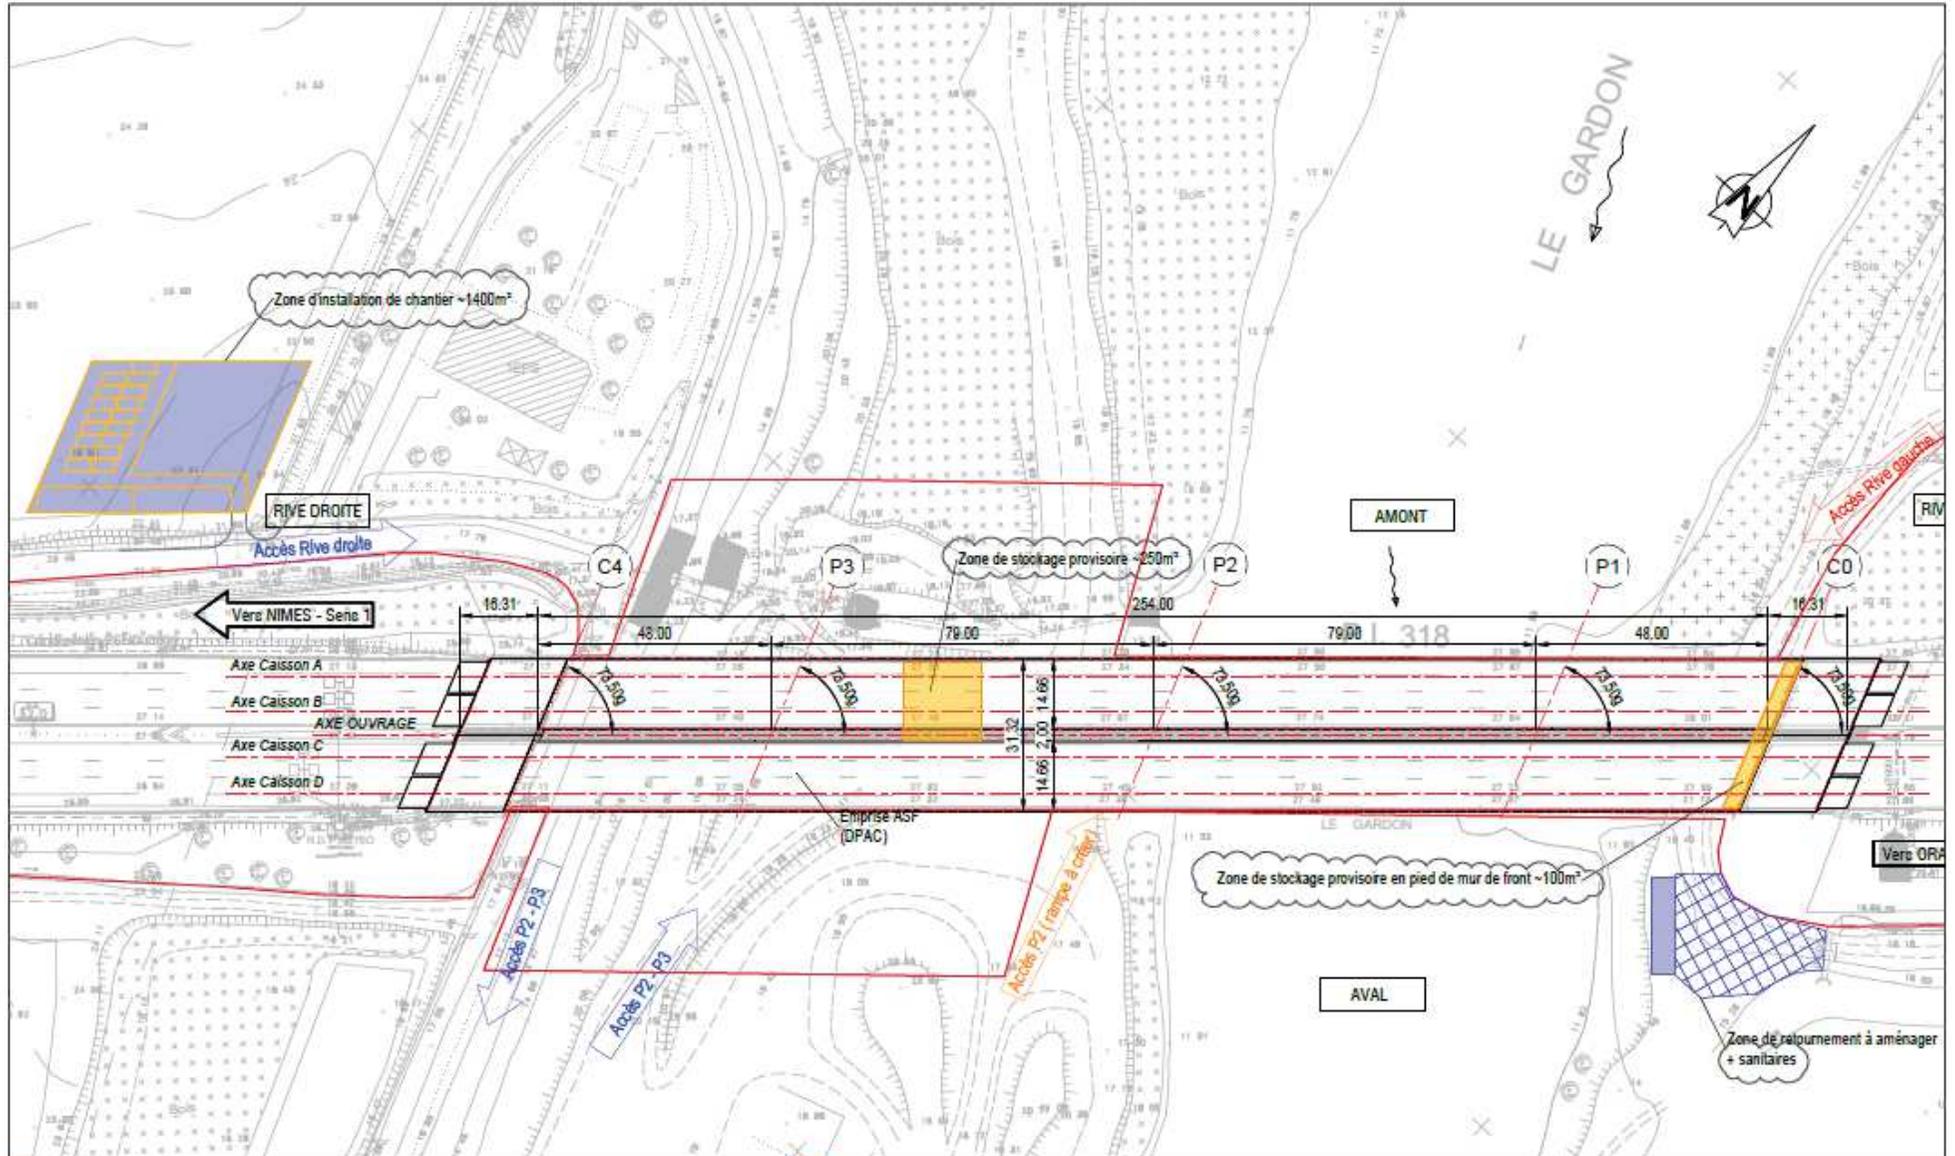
Vue en plan général des accès et installations (Arcadis, 2021)
